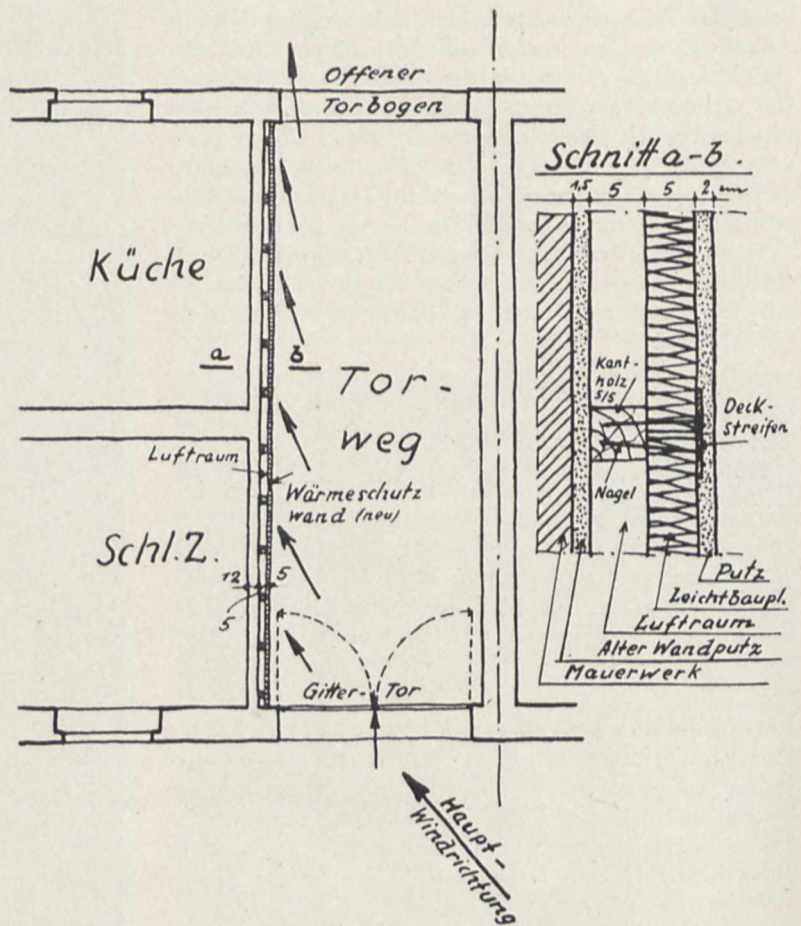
Verbesserung des Wärmeschutzes durch Einbau einer Leichtwand mit Luftschicht
